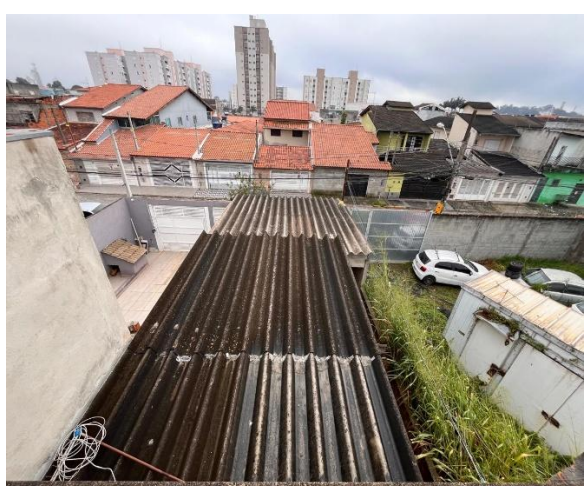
2º Pavimento: Vista da área externa dos fundos.
